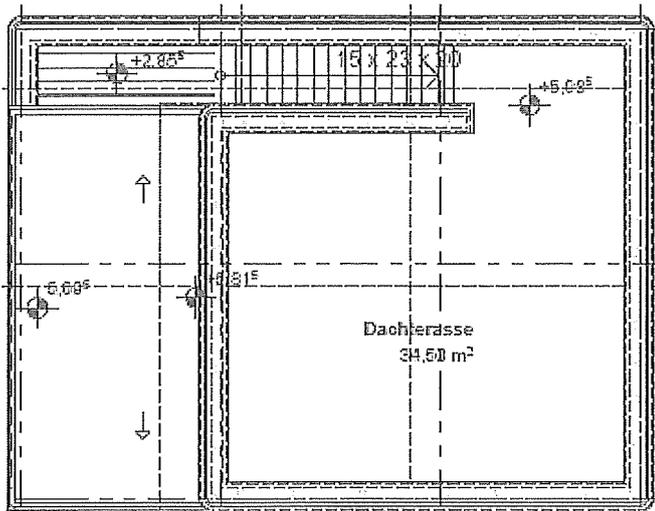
Grundriss der Dachterasse des FH 95
